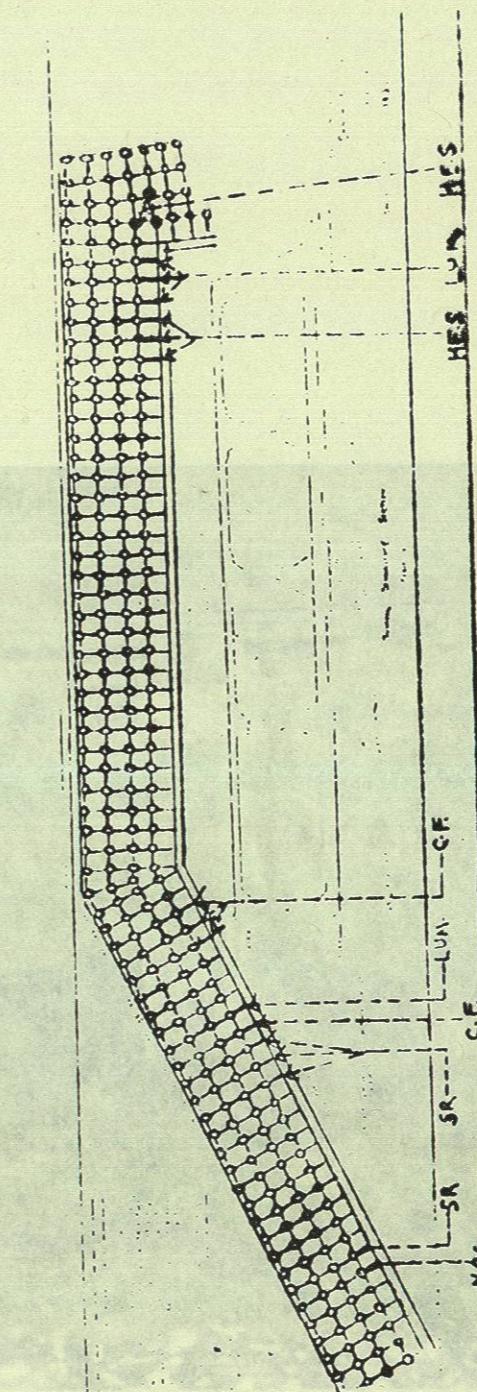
Reconstrucción de los atracaderos 1-3-4-5 - Plan récord, Puerto de St. John, 1936. Muestra la localización de las armaduras y columnas usando cementos especiales. Cemento Portland ordinario C.P.O., resistente a los sulfatos, R. S., Cemento FONAL L.U.M. - Luminite, Alta resistencia inicial (Records Históricos, Puerto St. John, Canada Cement Lafarge Ltd.).
